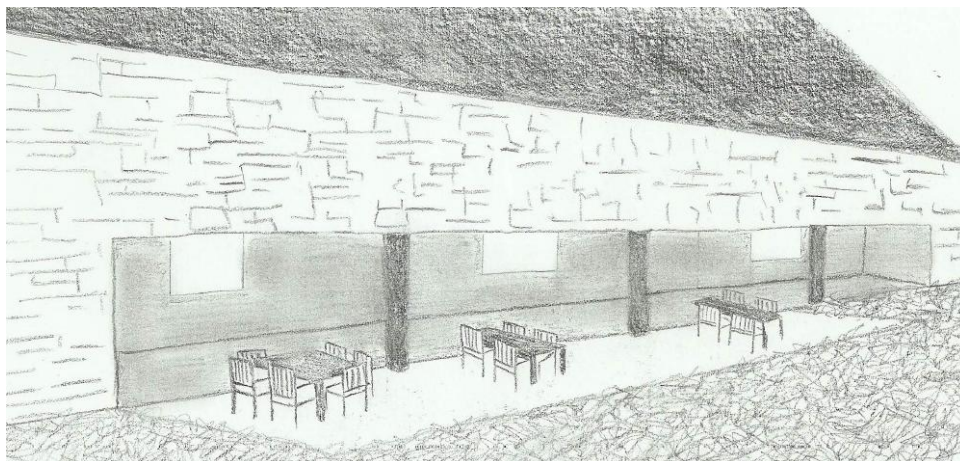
Représentation de la façade Est du bâtiment Est, terrasse donnant sur le parc
